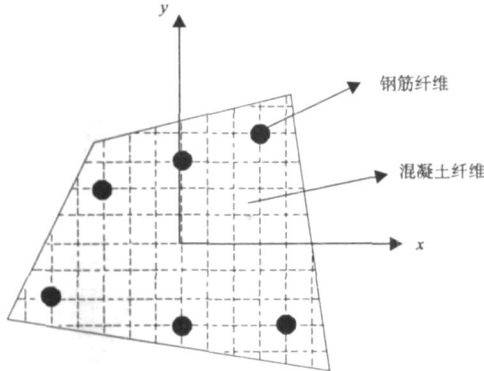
纤维模型的截面划分 (钢筋混凝土构件)
